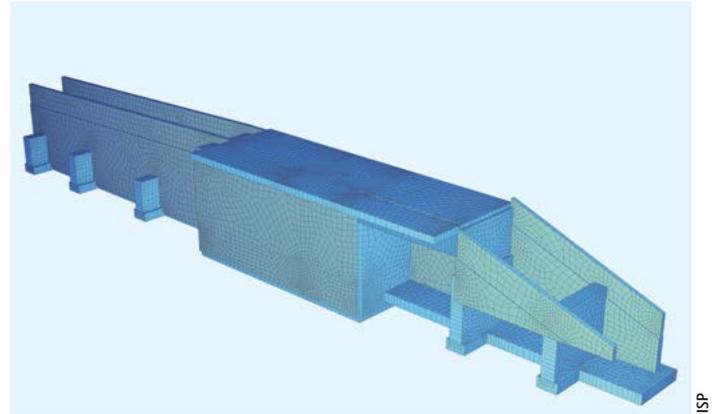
statisches Model der Schwergewichtskonstruktion inkl. Hausanschlussraum
